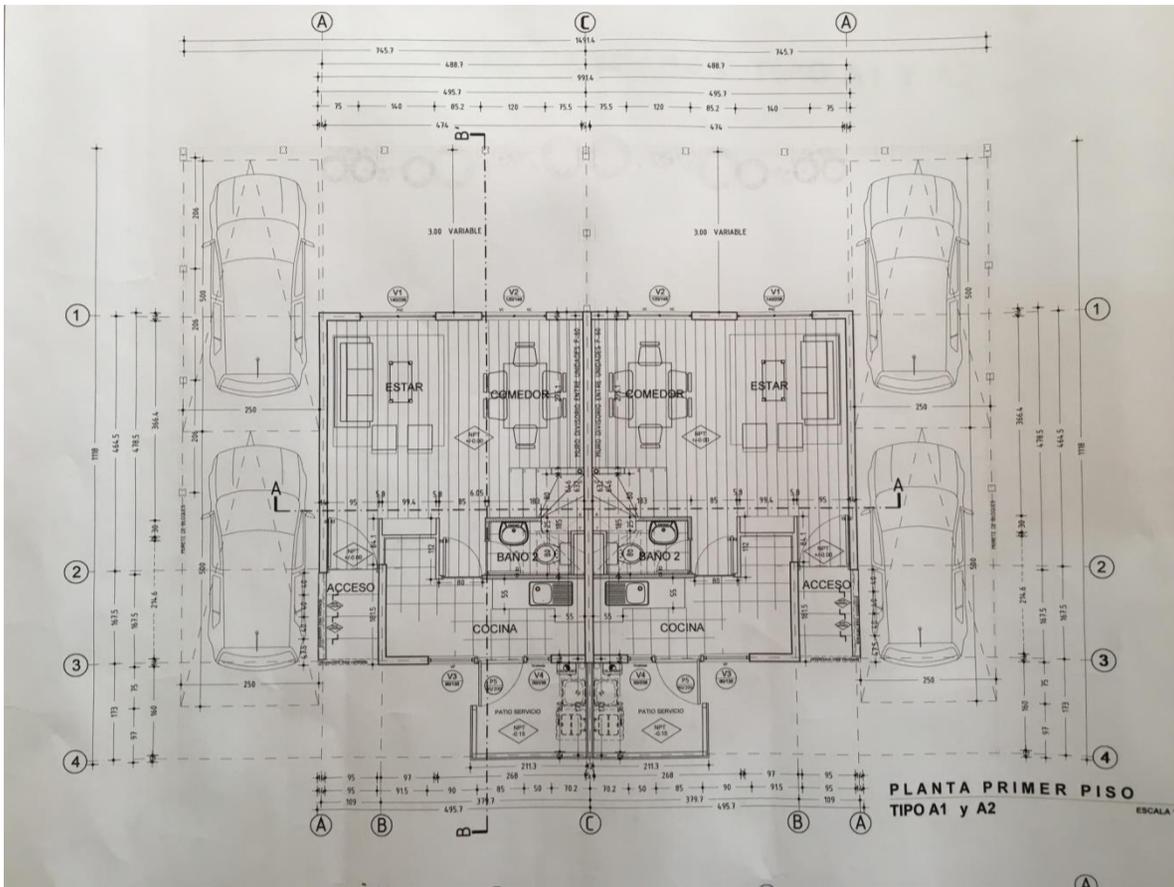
Planta primer piso casa pareada tipo A1 y A2.
